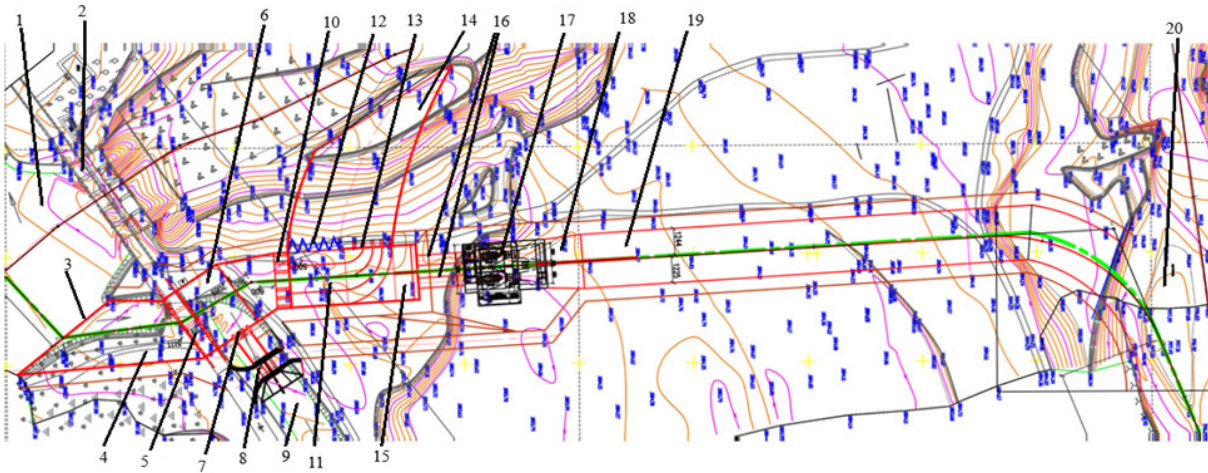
Плановое размещение гидротехнических сооружений по второму варианту: 1 – верхний бьеф существующего головного водозаборного гидроузла; 2 – подпорный створ водозаборного гидроузла; 3 – проектируемый водоприемный оголовок деривации; 4 – отводящий канал; 5 – автомобильный мост; 6 – регулятор; 7 – водовыпуск в ирригационный канал; 8 – трубчатый переезд; 9 – правобережный ирригационный канал; 10 – выдопуск в деривацию МГЭС; 11 – промывные галереи; 12 – автоводослив; 13 – промывники; 14 – холостой сброс; 15 – напорный бассейн; 16 – турбинные водоводы; 17 – здание МГЭС; 18 – сопрягающее устройство; 19 – отводящий канал; 20 – отводящее русло реки
